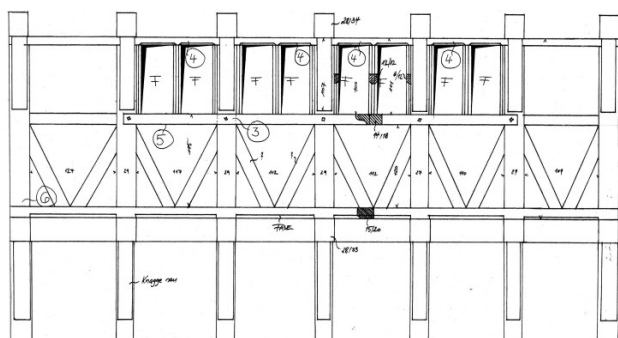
Göttingen, Rote Straße 25. Fachwerk des Oberstocks mit rekonstruierten Fensteröffnungen
